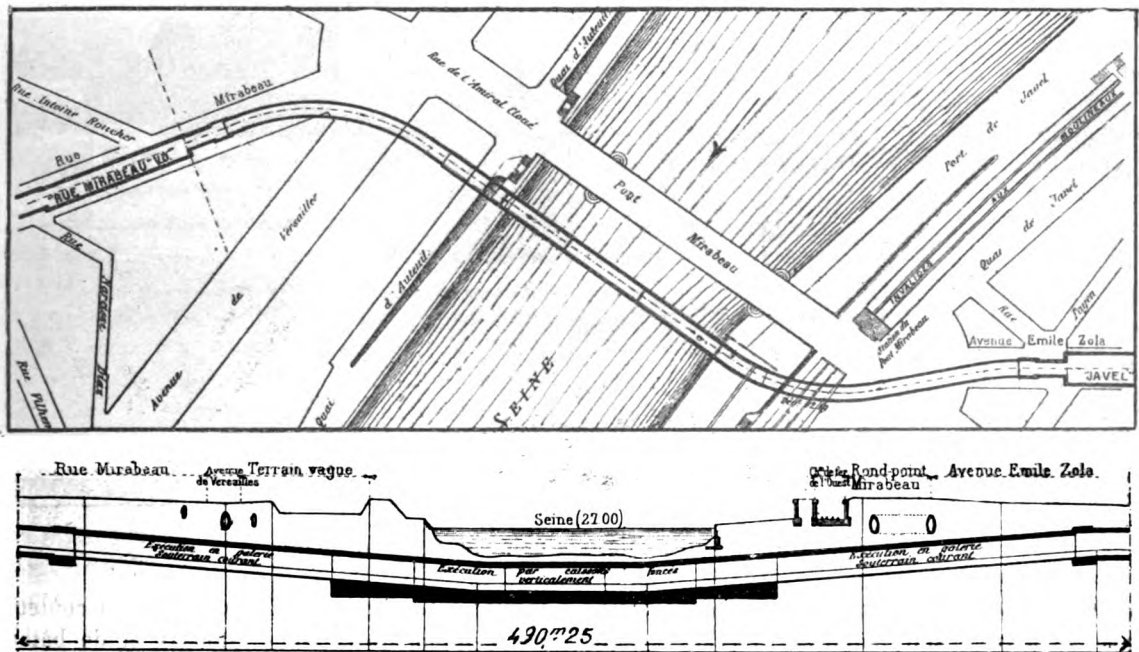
Plan et coupe de la ligne du Métropolitain au pont Mirabeau.
